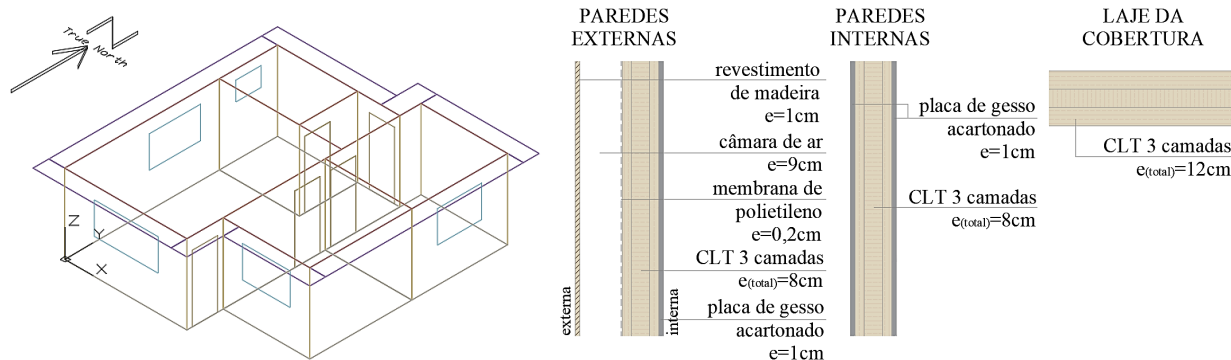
Geometria da edificação e configuração dos elementos de vedação.
